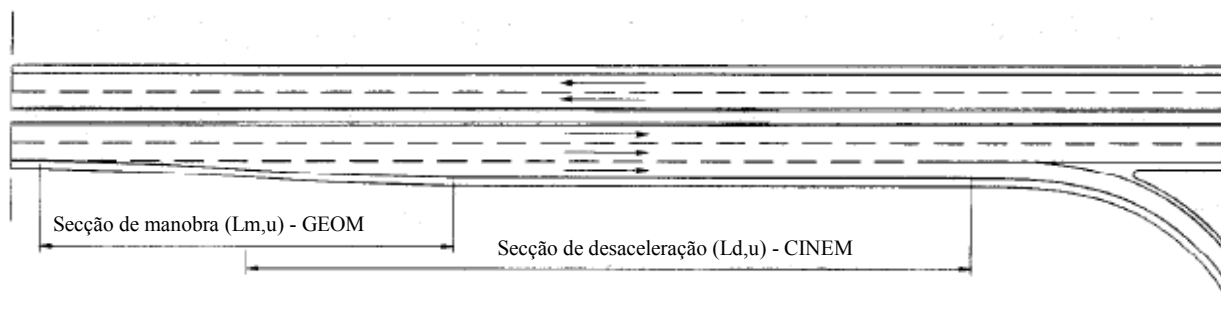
Via de desaceleração, tipo paralelo[10]
